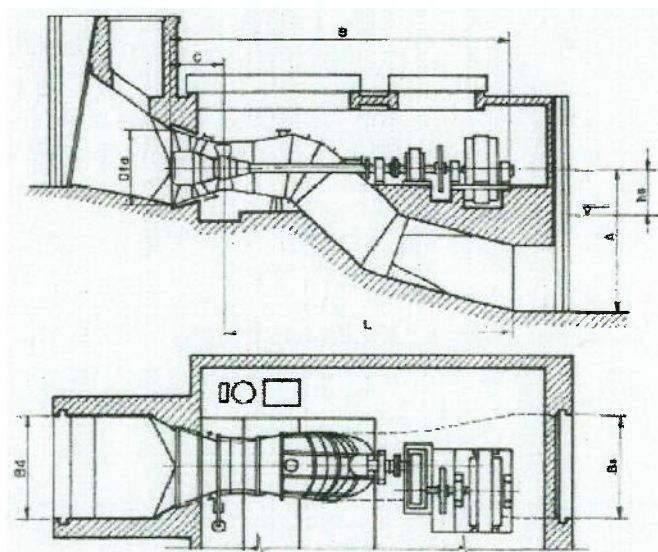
Dimensões Principais da Turbina Kaplan S.
